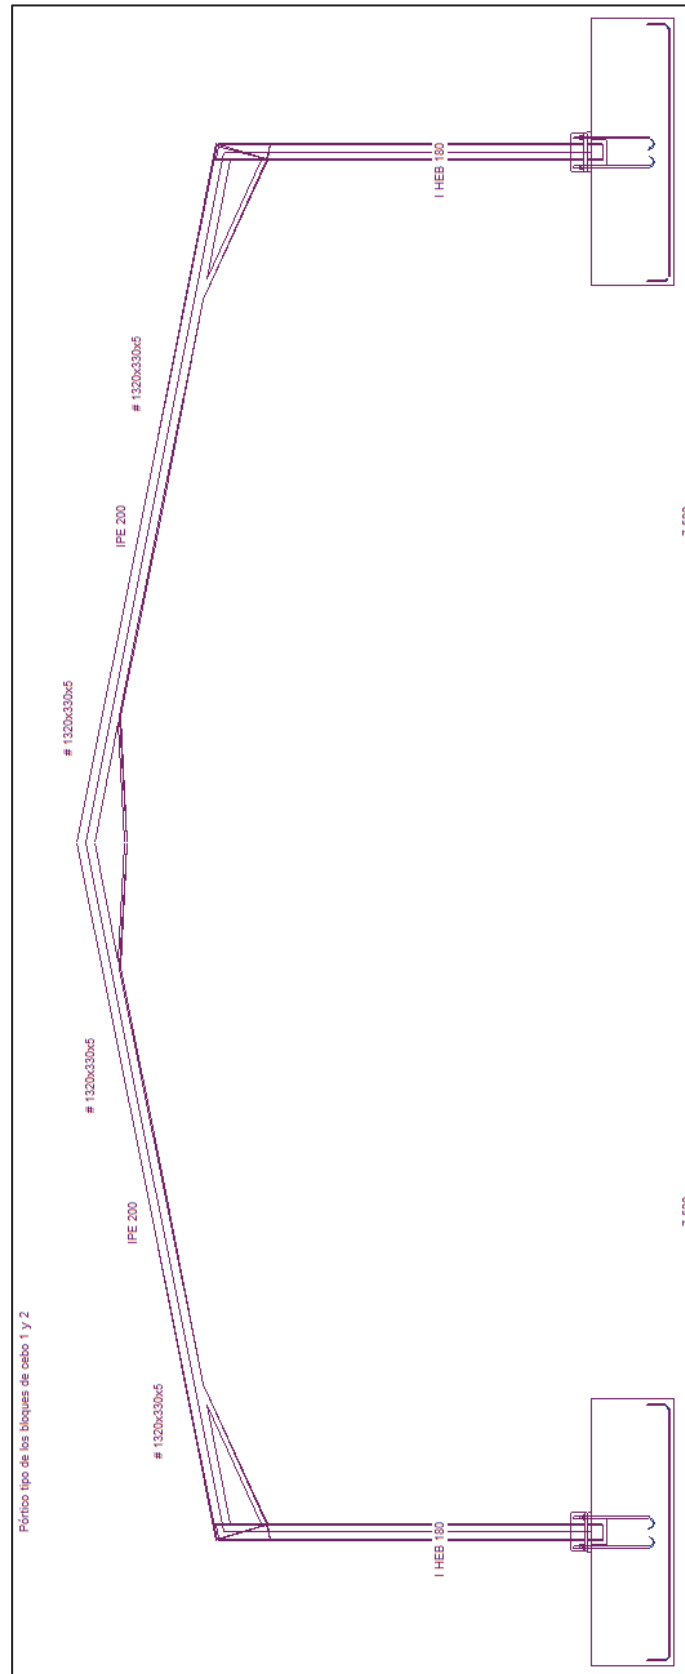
Detalle de los pórticos tipo de los bloques de cebo 1 y 2.
